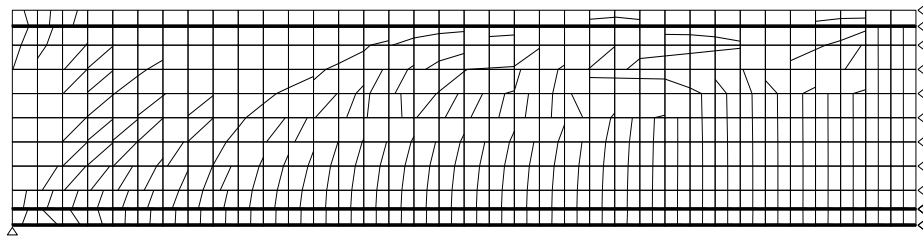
Fendilhação para a viga tipo B submetida à carga de rotura
